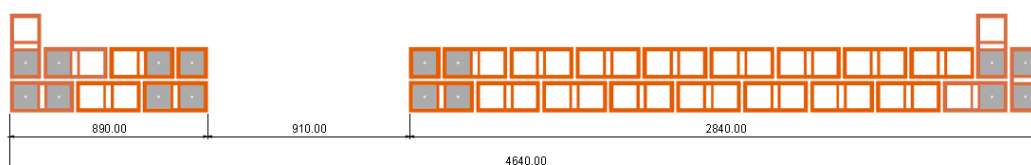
Disposizione mattoni prima fila con rinforzo, parete porta
